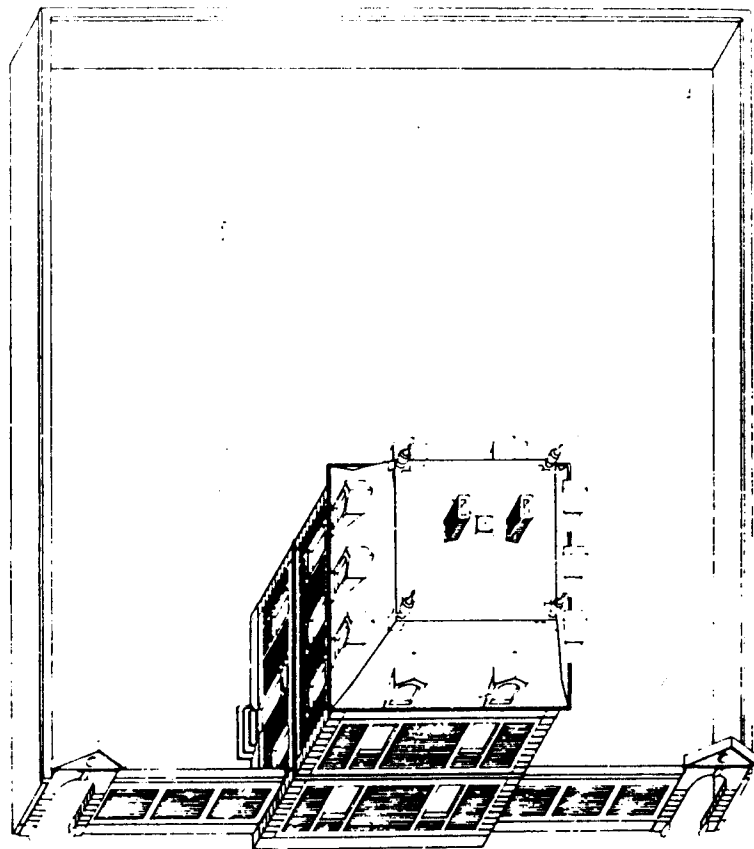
Constance de l'architecture de compromis et de sa traduction en plan, de Mulhouse au M. R. U.
